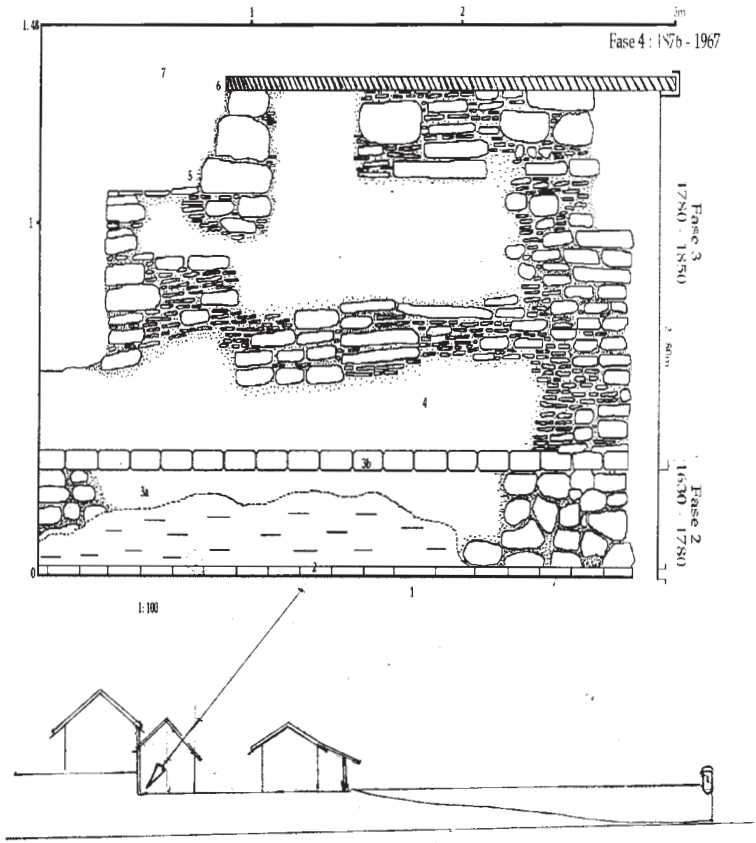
Fases constructivas. Muro de la fachada sur de la antigua sala de enfermería, vista sur.
